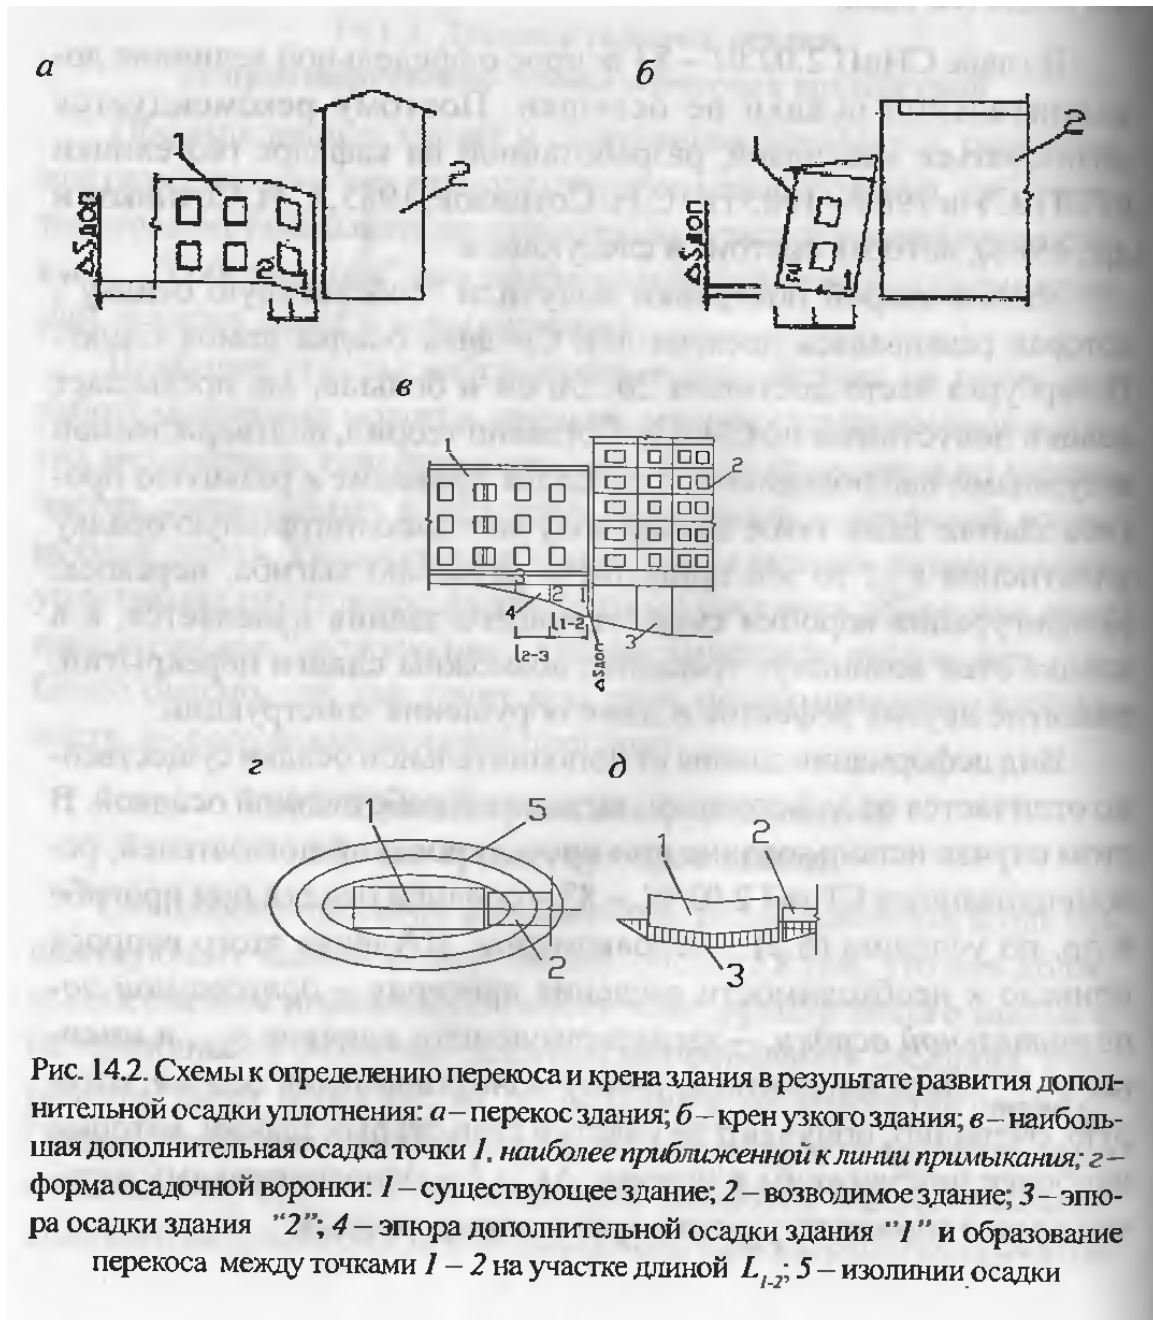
Схемы к определению перекоса и крена здания в результате развития дополнительной осадки уплотнения: а – перекоса здания; б – крен узкого здания; в – наибольшая дополнительная осадка точки 1, наиболее приближенной к линии примыкания; г – форма осадочной воронки: 1 – существующее здание; 2 – возводимое здание; 3 – эпюра осадки здания “2”; 4 – эпюра дополнительной осадки здания “1” и образование перекоса между точками 1 – 2 на участке длиной L_{1-2} ; 5 – изолинии осадки
